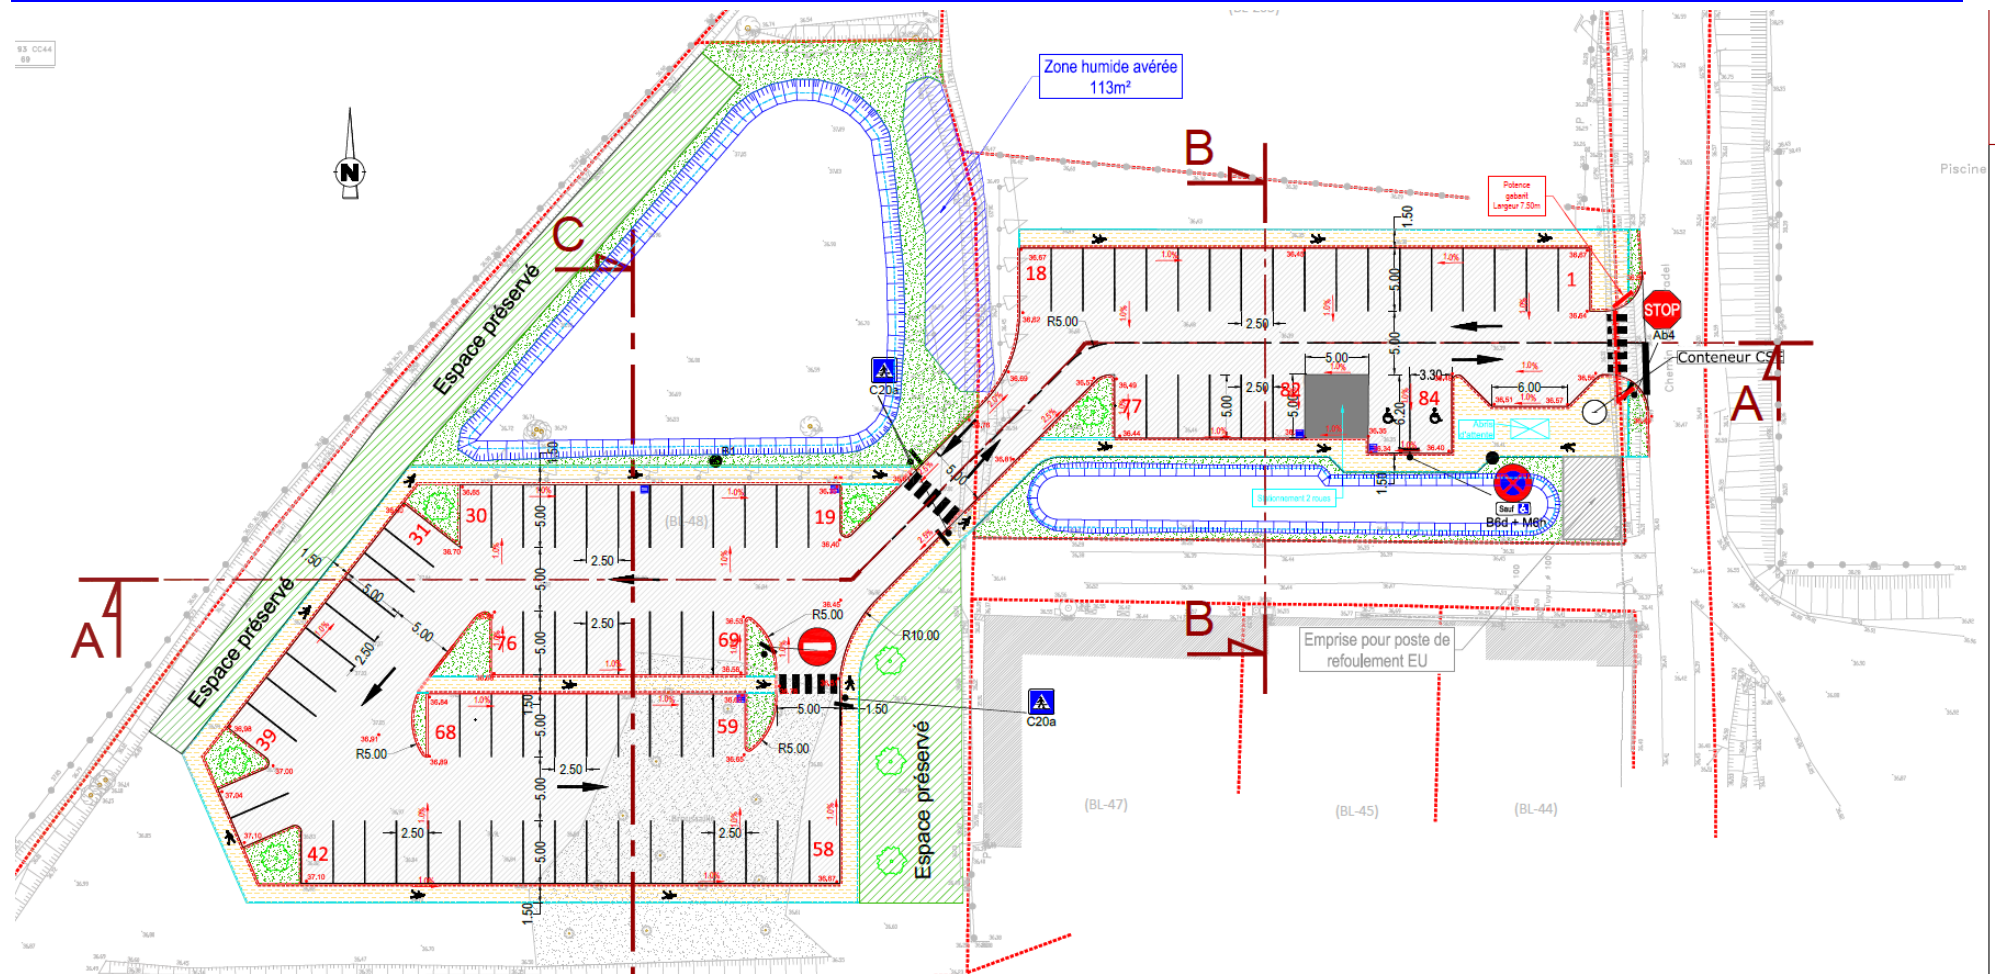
Plan de masse du projet (Source : Pro-Ing, 2020)
